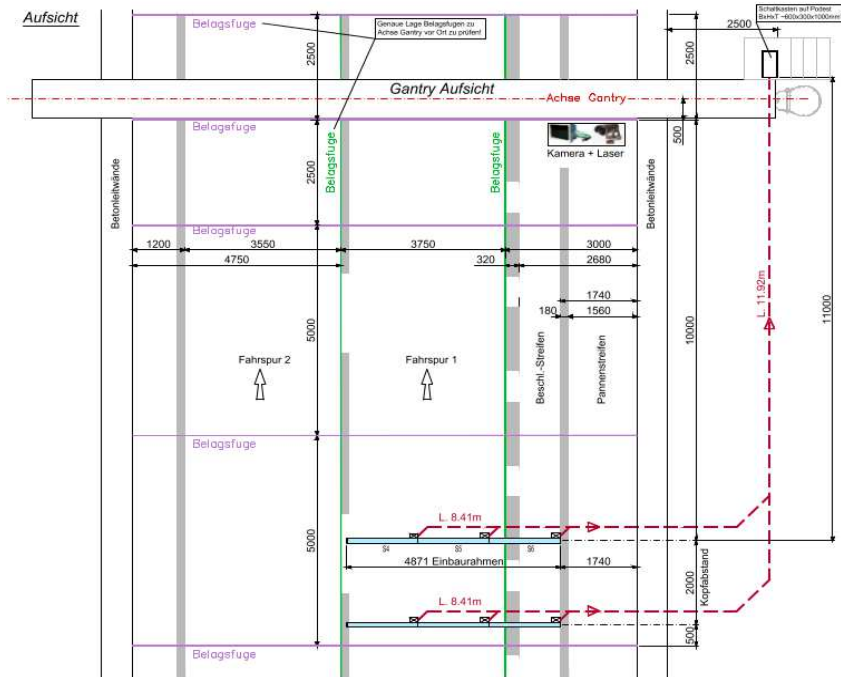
Einbauplan Aufsicht (von Oben) mit dem Layout der WIM Sensorik
